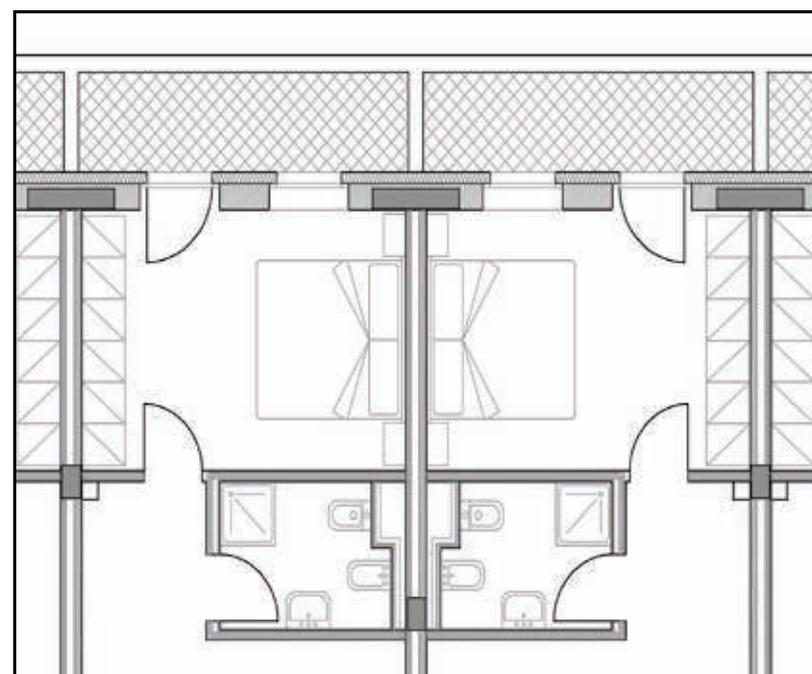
Pianta degli ambienti oggetto delle misurazioni.
